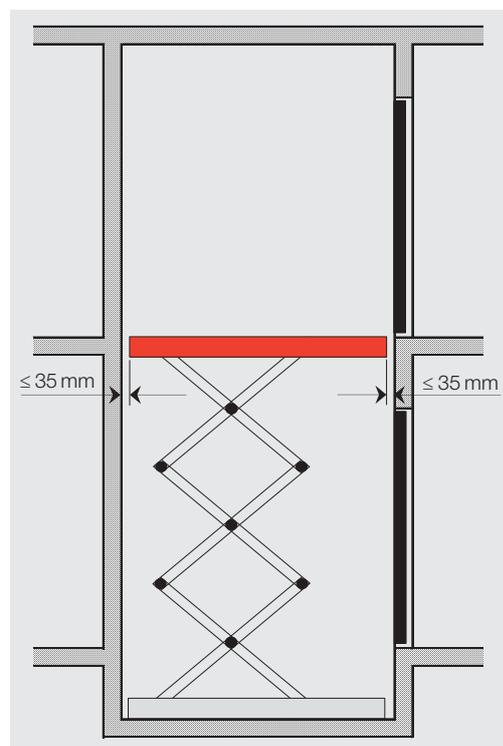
cabina con distanza massima di 35 mm rispetto alle pareti del vano
